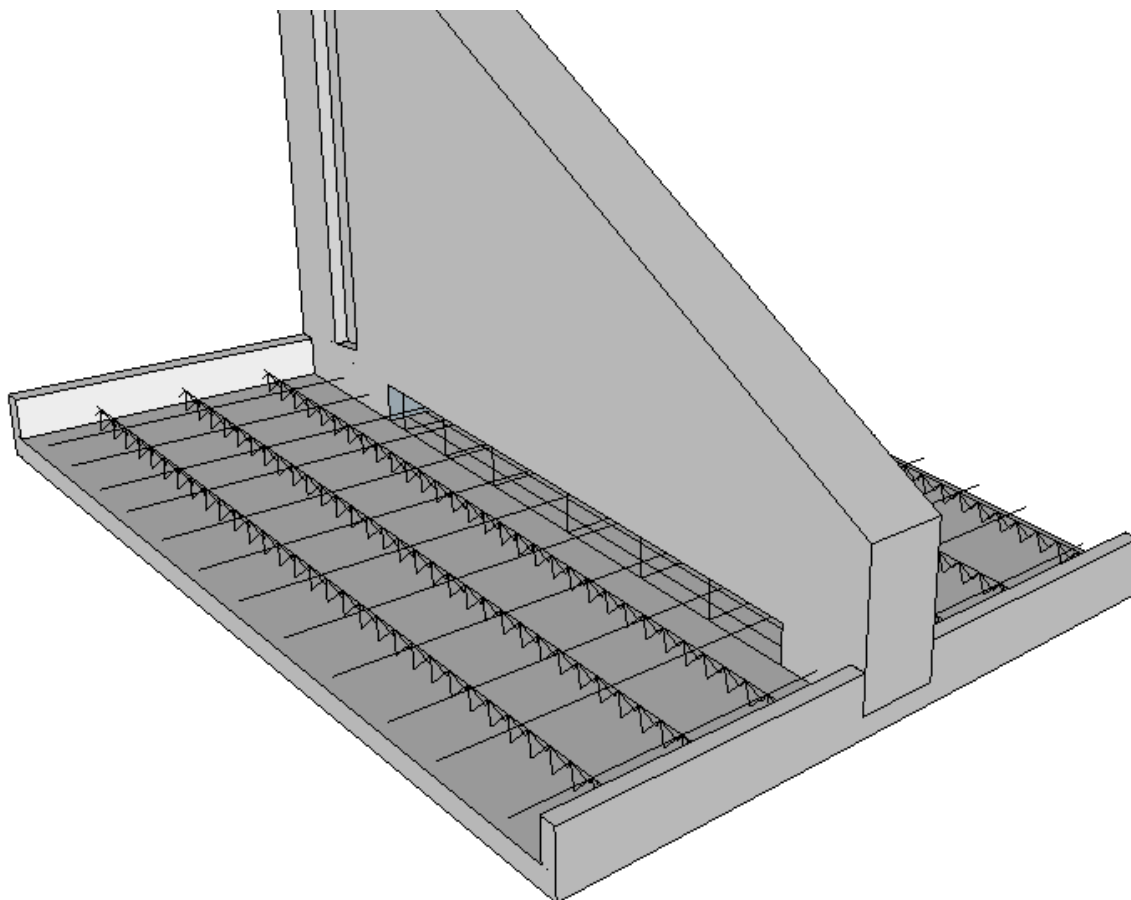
Esquema da ligação entre placa de fundação e contraforte
